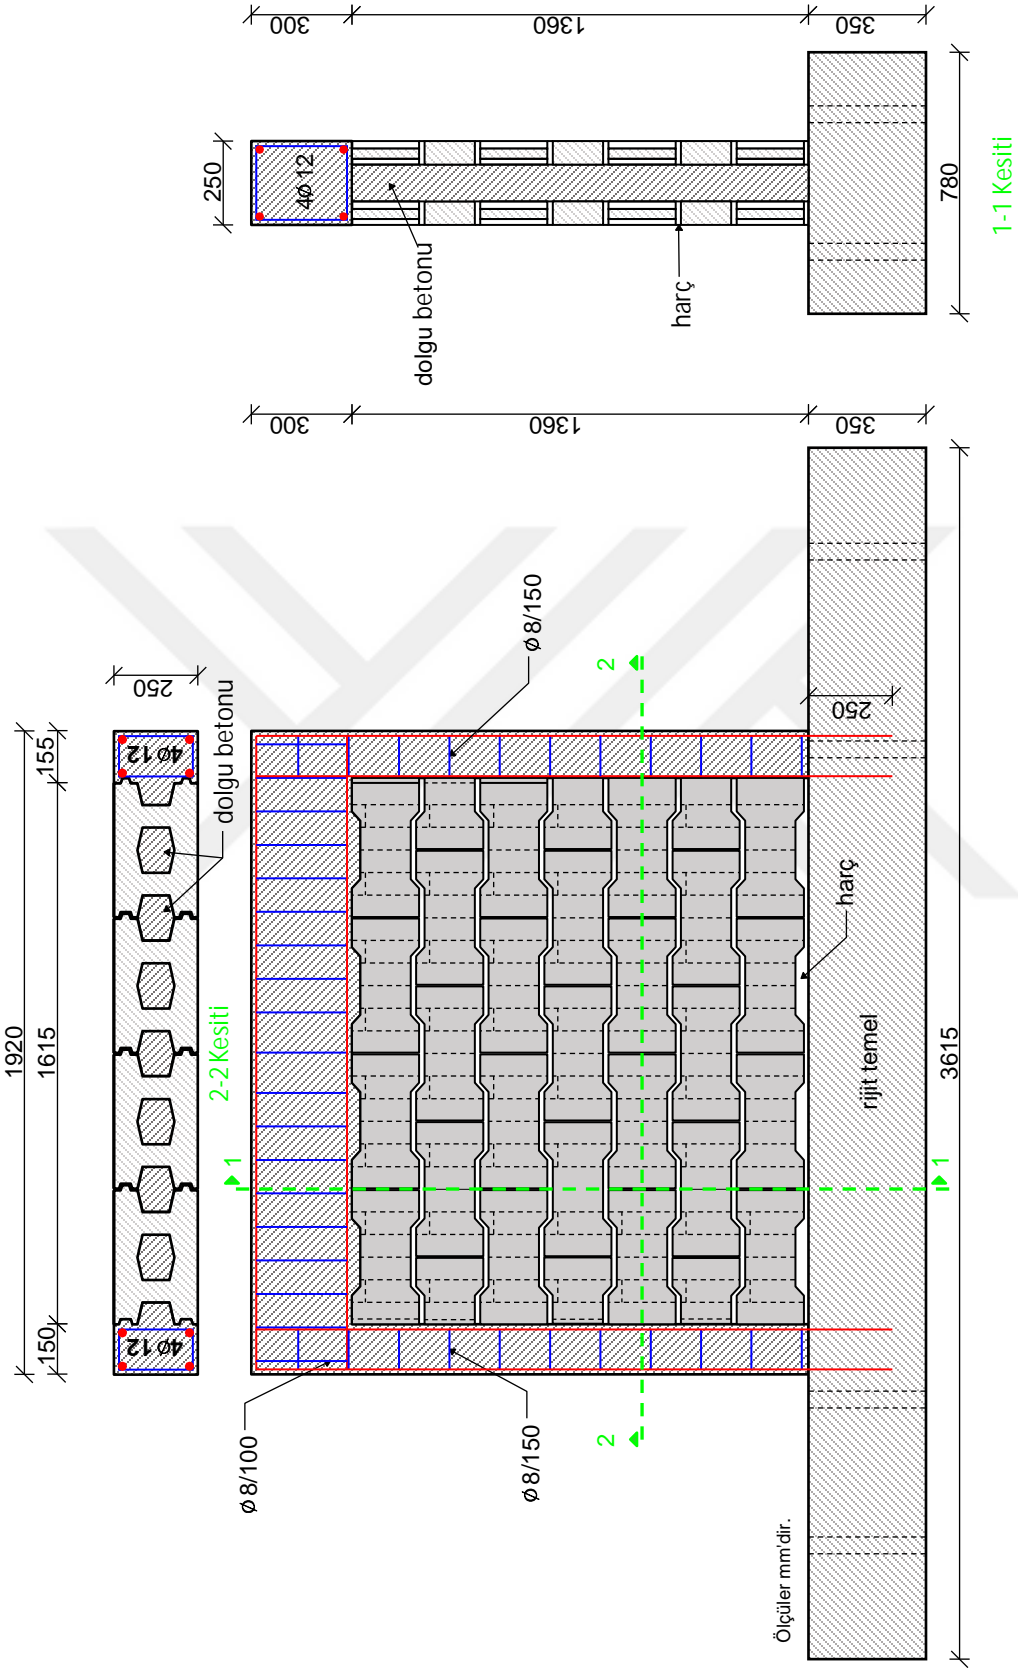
GYDDE deney elemanı boyut ve donatı detayları
